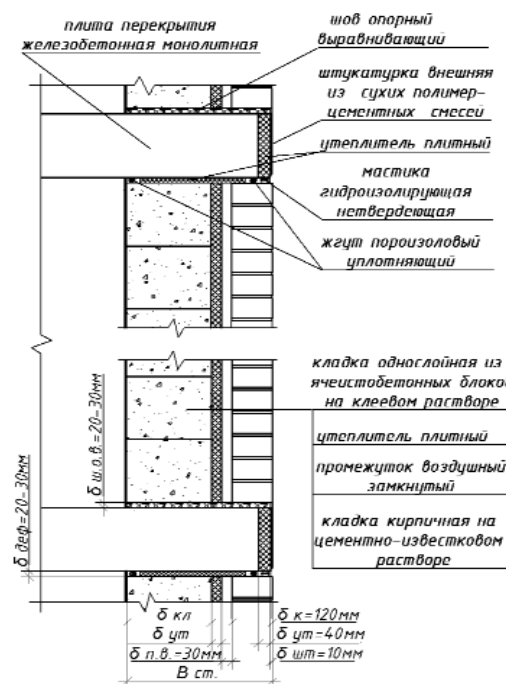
Стена трехслойная из ячеистобетонных блоков и плитного утеплителя с обкладкой лицевым кирпичом
